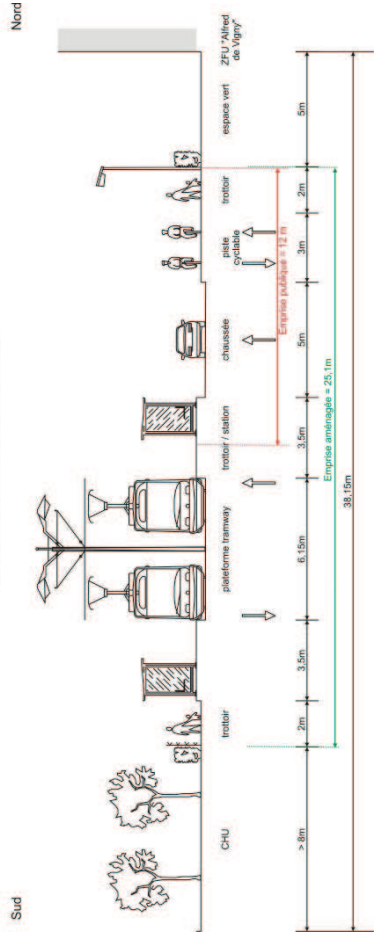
situation existante coupe sur l'avenue Molière, station "Molière Est"
